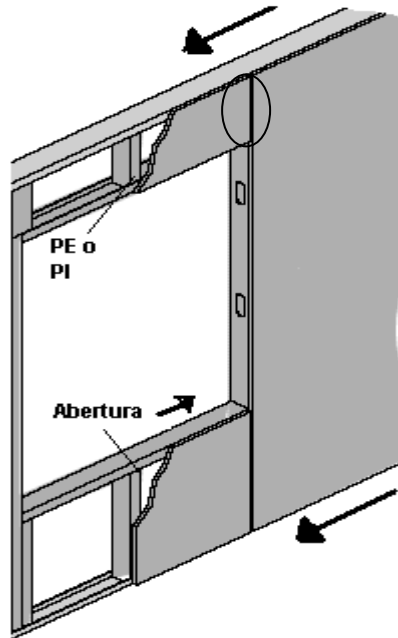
Detalle de ensamble en estructuras de soporte para vanos de puertas y ventanas
